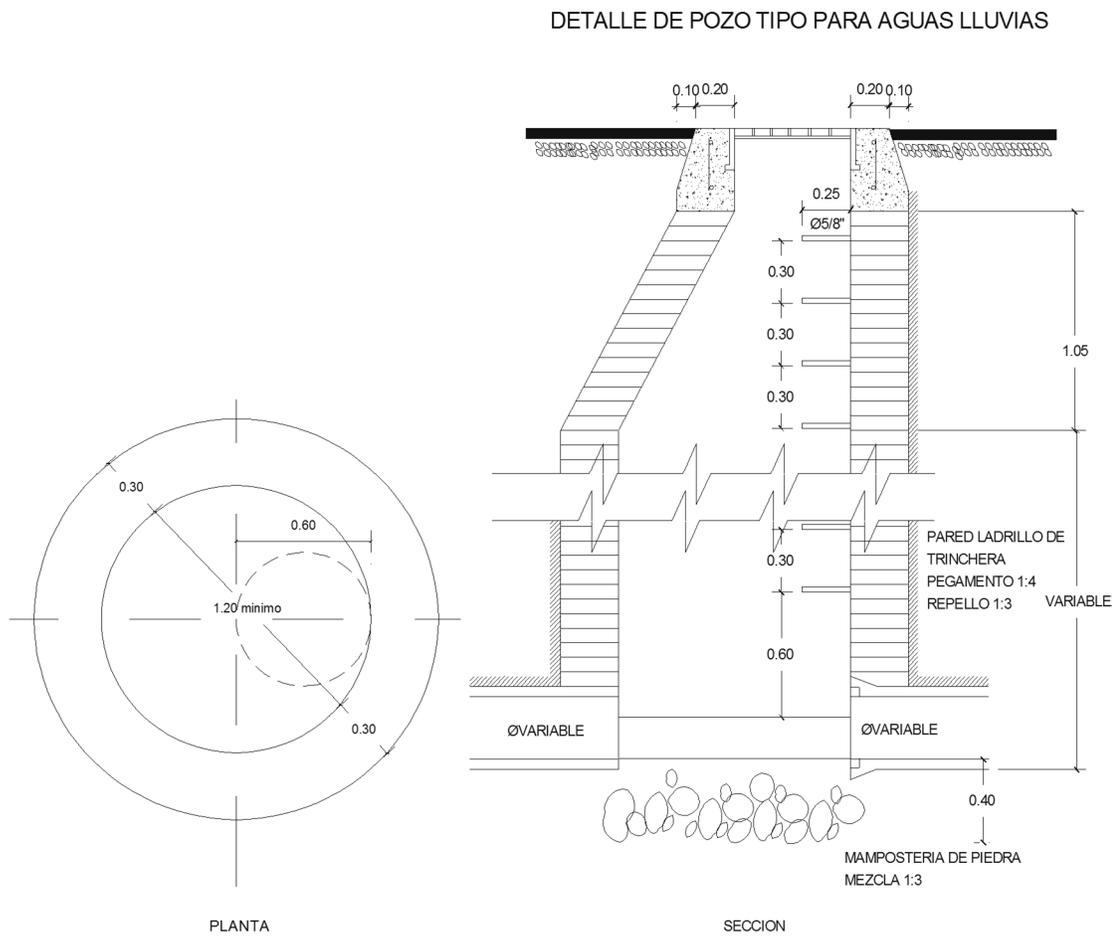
Detalle de pozo de visita de aguas lluvias.
